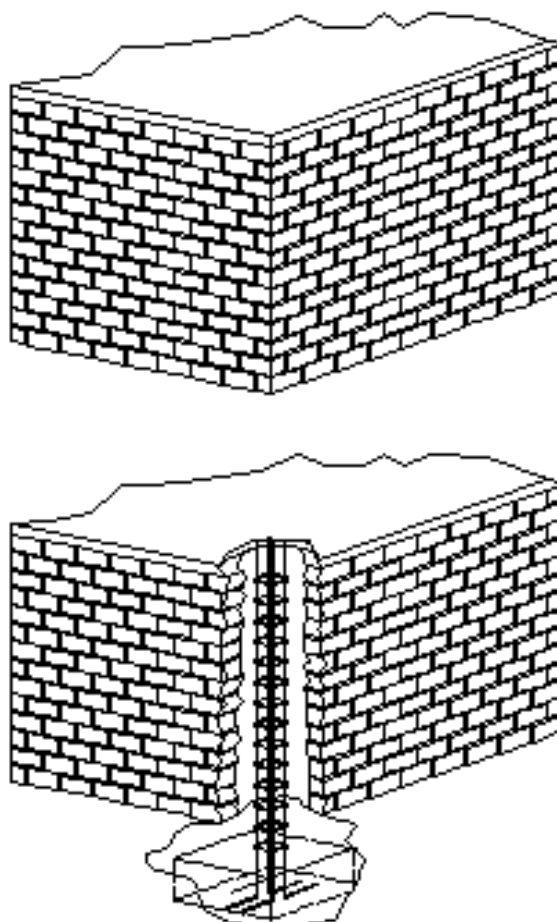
Detalle de inclusión de columnas de reforzamiento en muro sin confinamiento existente
